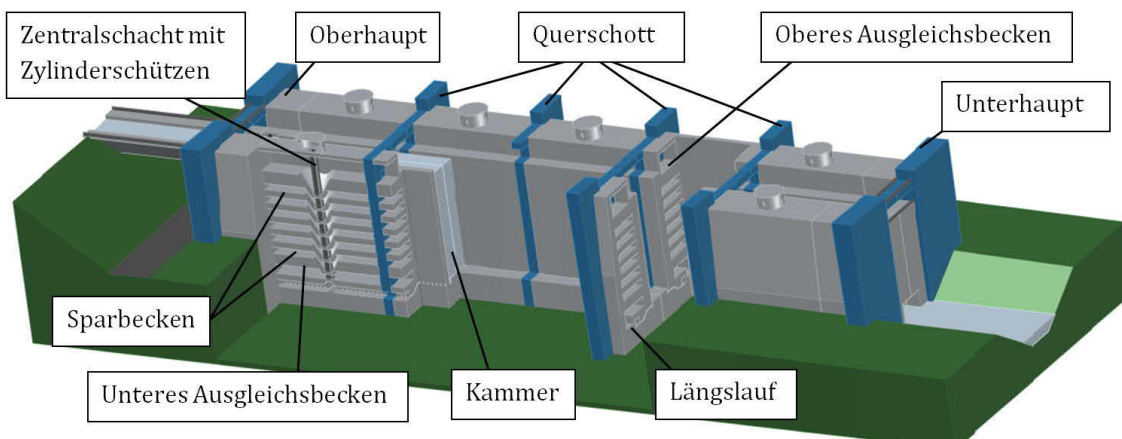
Dreidimensionale Darstellung des Bauwerks mit wesentlichen Tragwerks- und Konstruktionselementen
